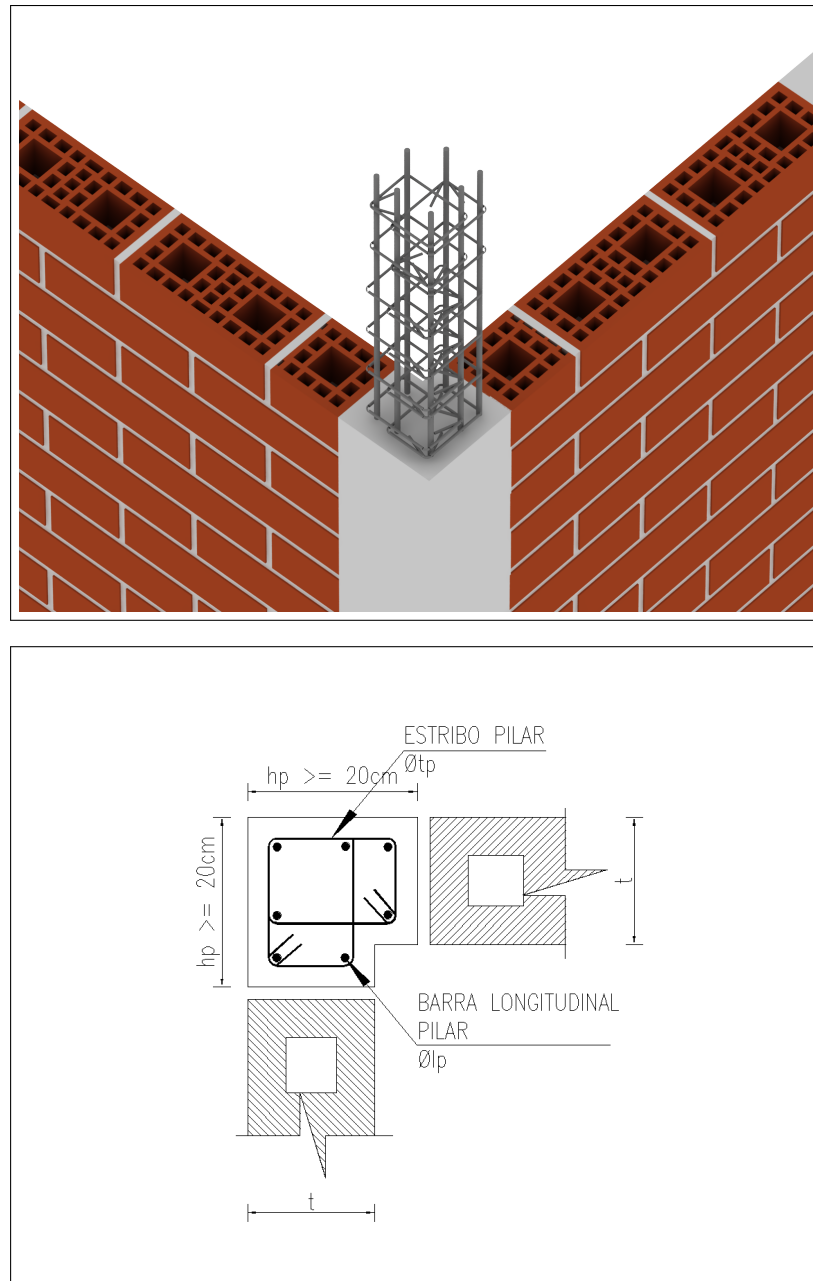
Dimensión mínima de un pilar para un encuentro de muros en L y armado considerando que en ambas direcciones actúa como pilar de borde libre
